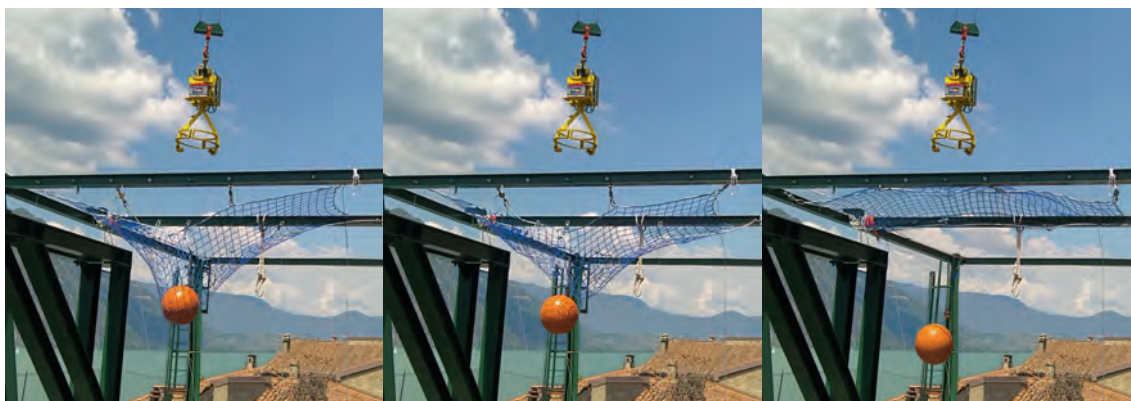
11 - Rete rettangolare 2x4 (m) h = 2 m - Sfondamento della rete (fermo immagine)
